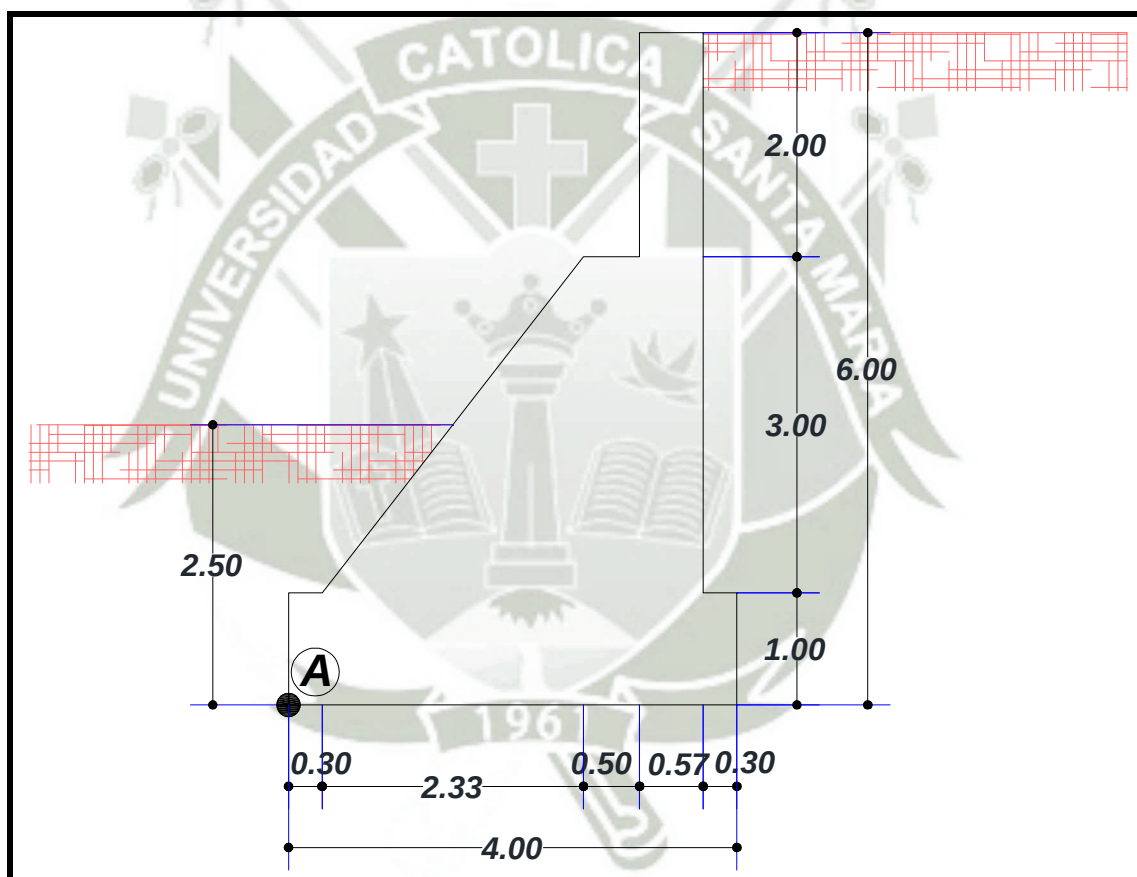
Pre-dimensionamiento de Estribos por Gravedad en Concreto Ciclópeo,
